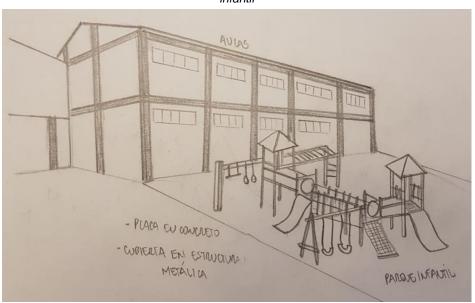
Bosquejo perspectiva emplazamiento de cubierta y placa de concreto
